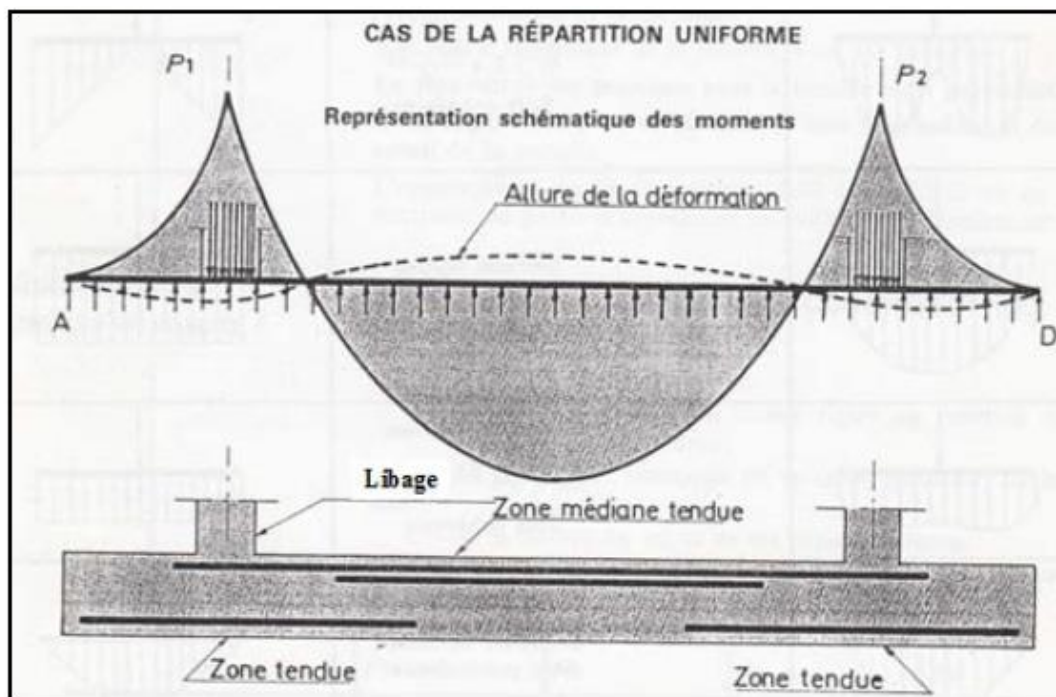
Schéma de principe du fonctionnement d'une semelle filante et disposition des aciers
